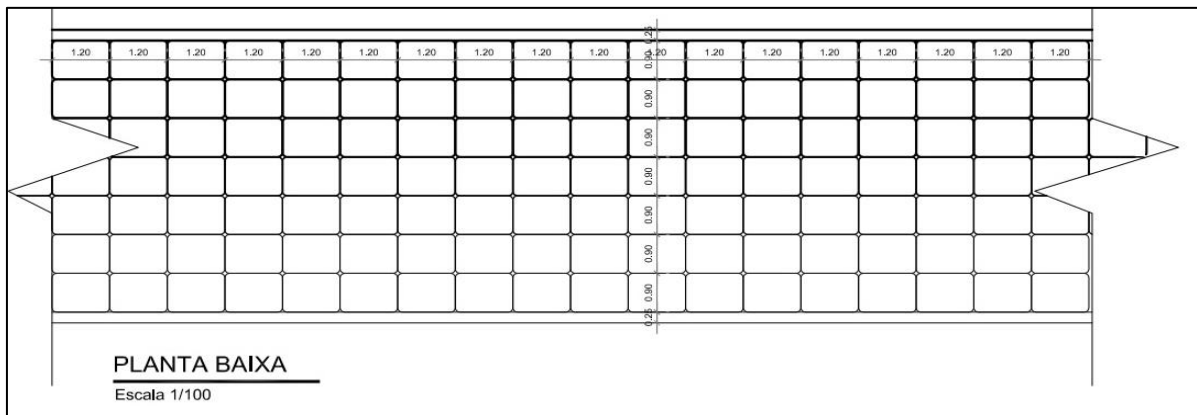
Planta Baixa do projeto de intervenção de Bagwall
